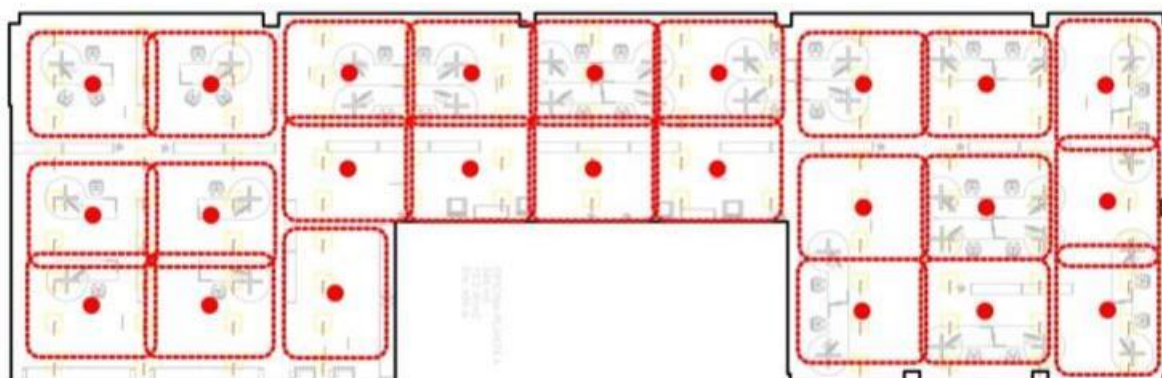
Distribución de Sensores. Área de Trabajo. Planta 4
